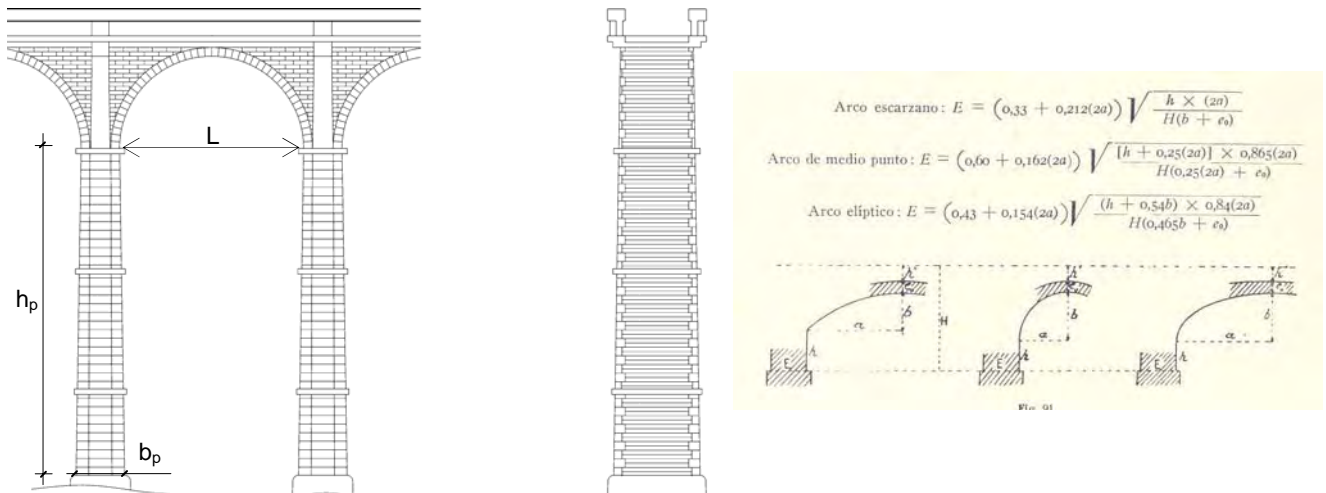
a) Geometría de una pila de talud constante b) Reglas de Leveillé para el espesor en el pie de estribo
